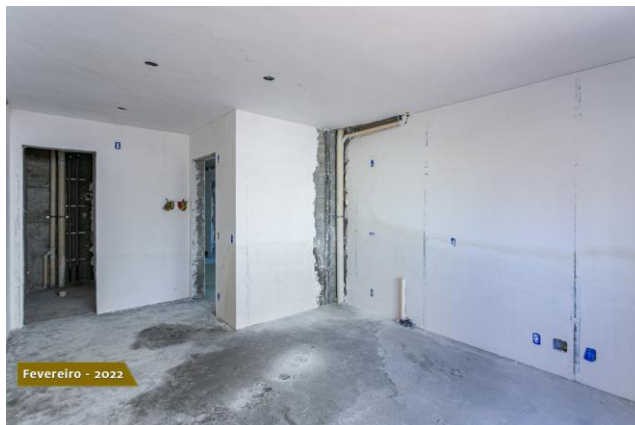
Parede em pavimento finalizada com massa, detalhe para tubulação hidráulica
